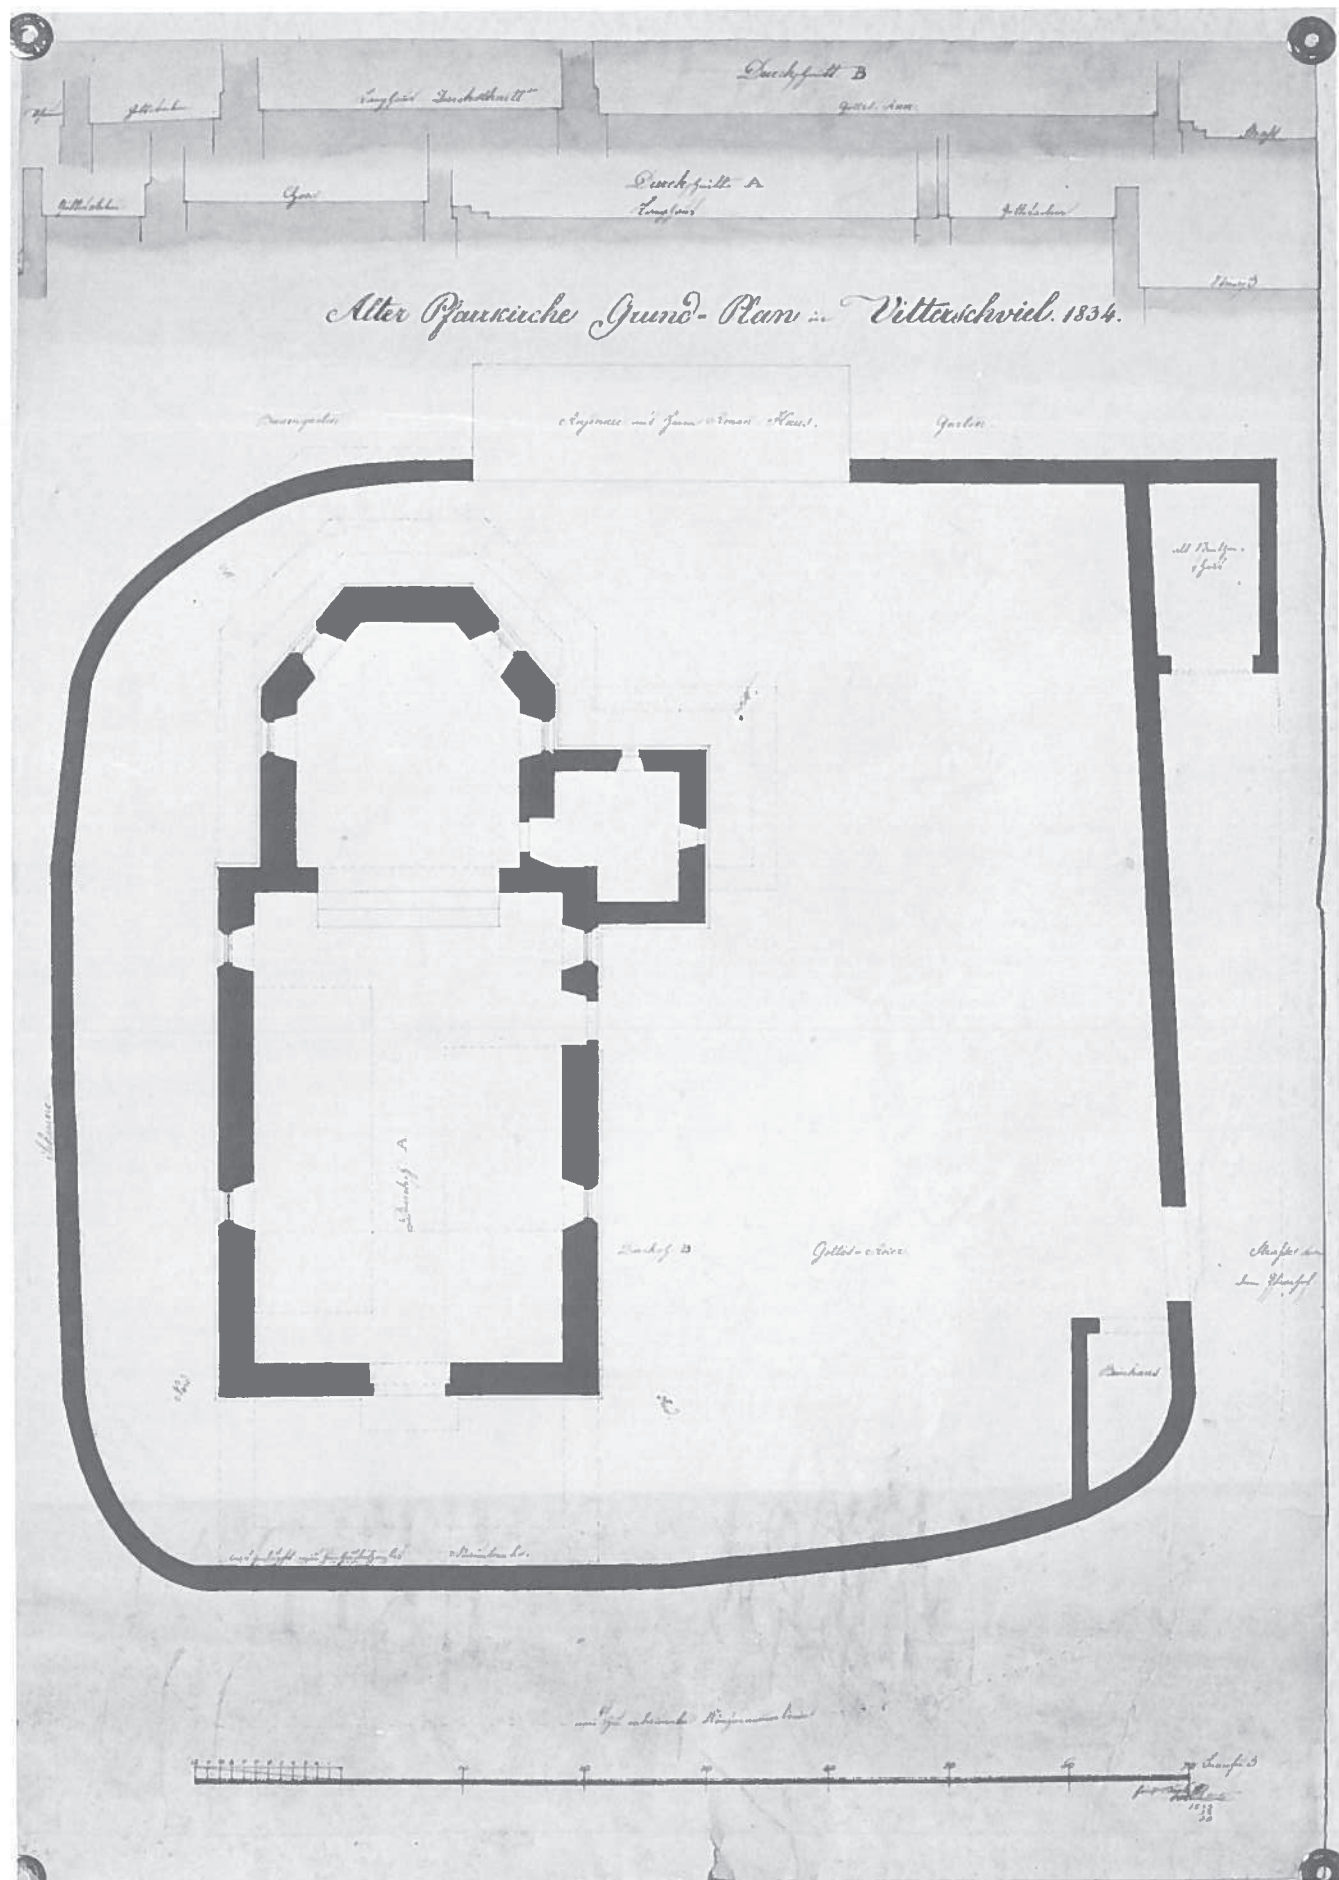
Grundriss von 1834 mit der Kirche von 1640/41 (schwarz) und dem Umbauprojekt (dünn gestrichelt).
